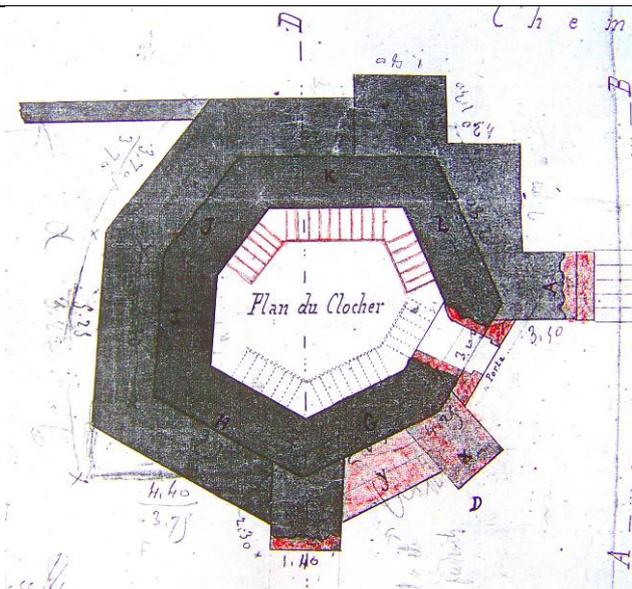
Extraits du plan relevé en 1872 avant travaux de restauration de la tour.
